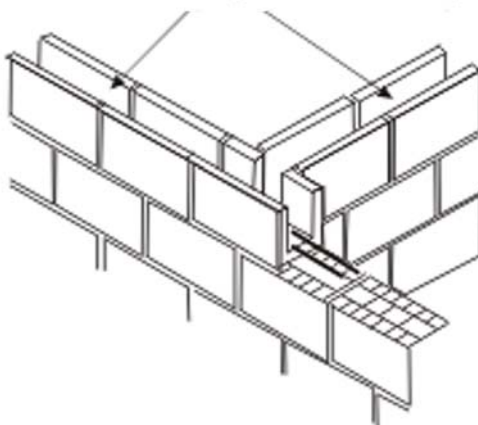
Barras de vinculación en intersecciones de muros.
